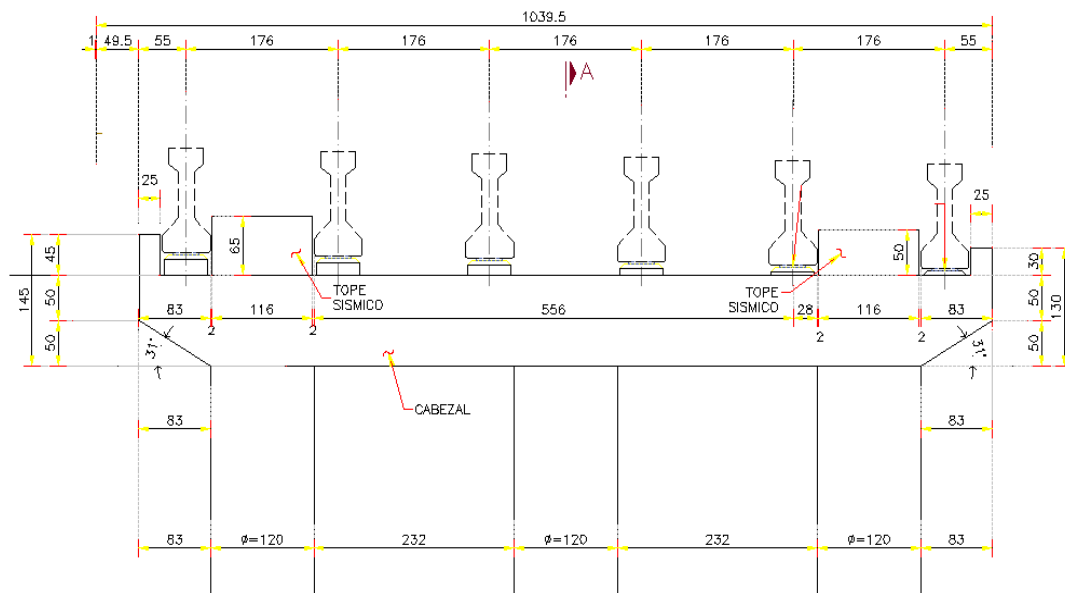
Sección y dimensiones de la viga cabezal en la cual se apoyan las vigas AASTHO (unidades en cm)
